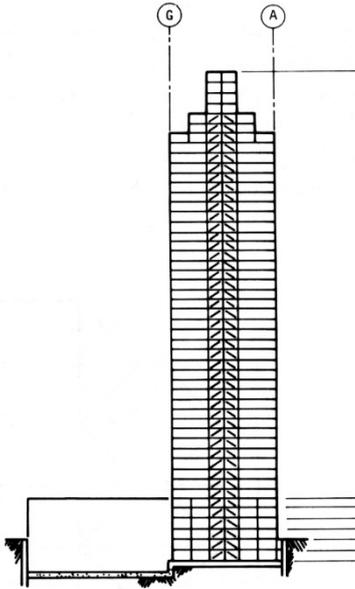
Aussteifendes Fachwerk in einem Hochhaus [59]
